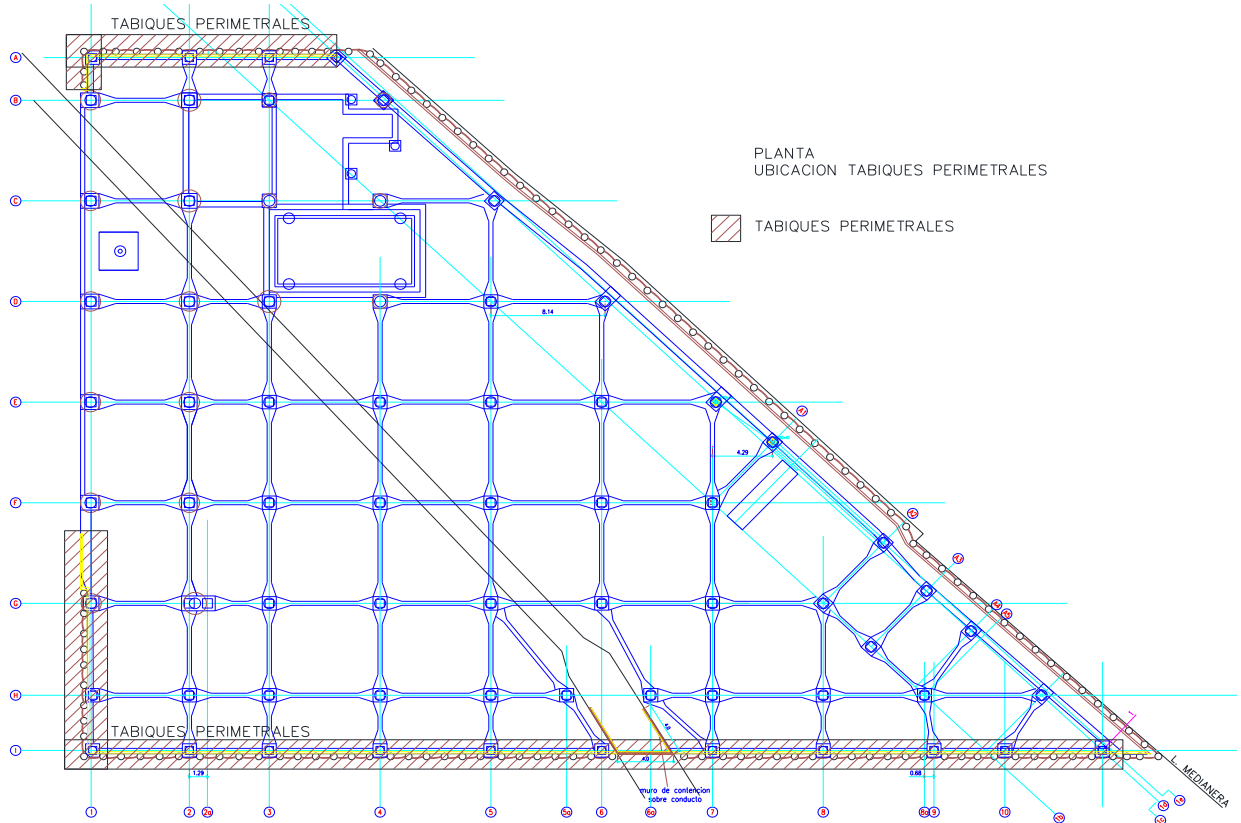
Planta con la ubicación de los tabiques perimetrales.
